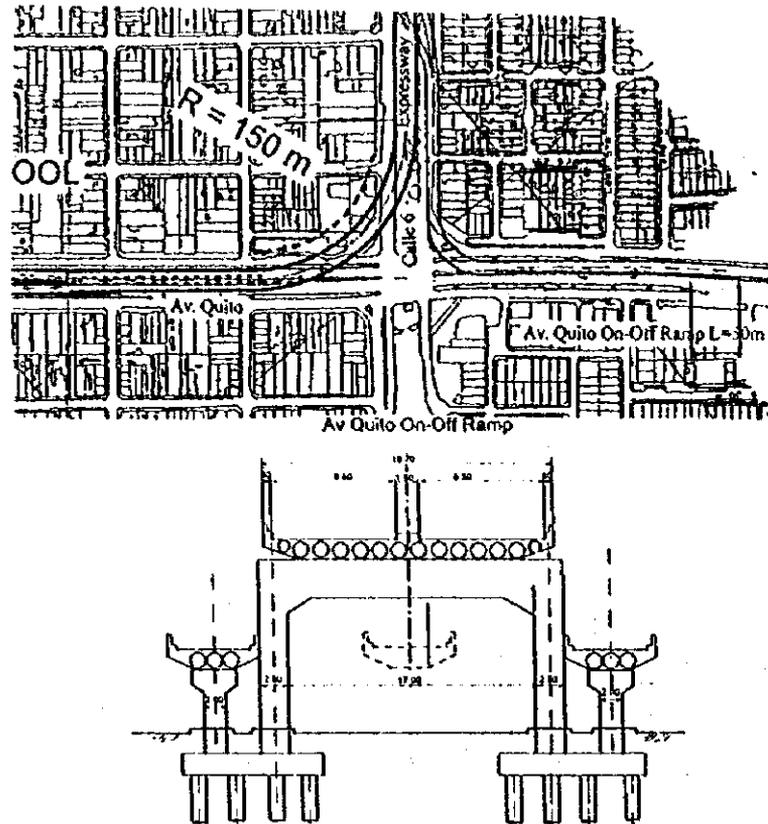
Rampa de Entrada y salida sobre Avenida Quito - Calle 6
